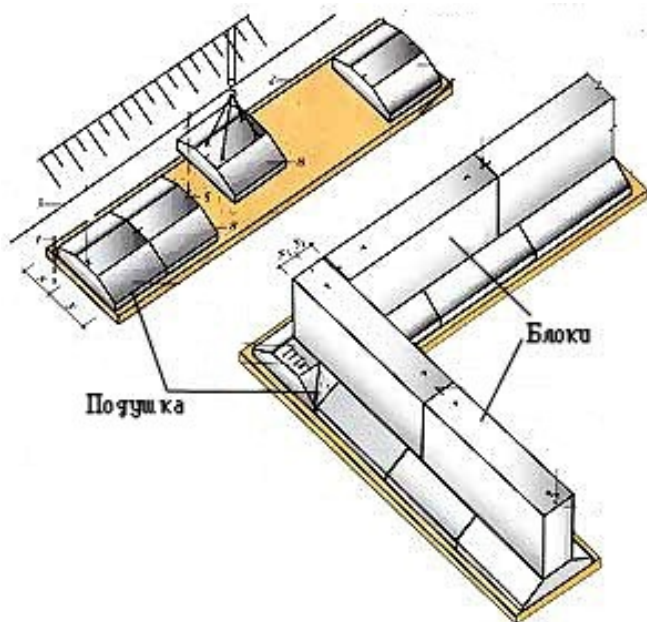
Стрічковий фундамент Рис. 5.6. Фундамент на палях:
